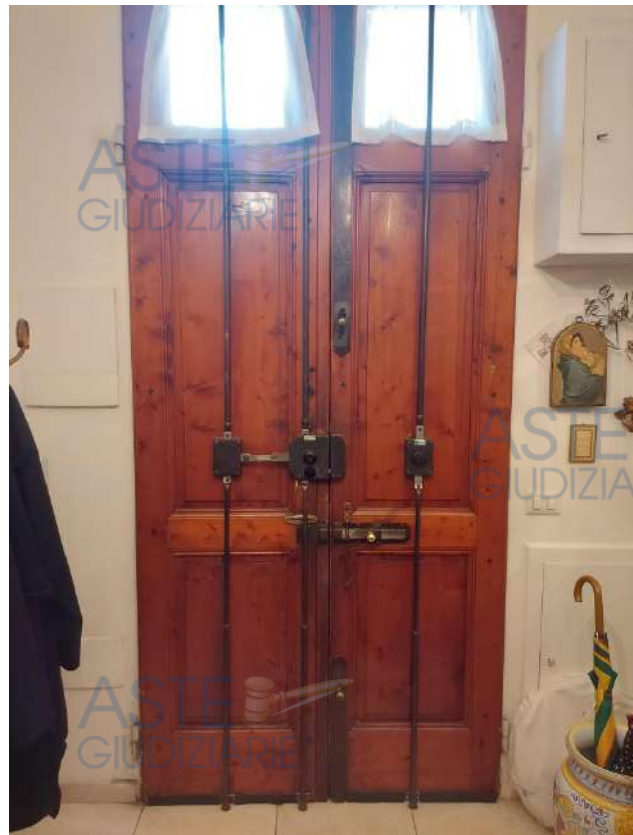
piano terra – Ingresso 1 – portone ingresso principale
